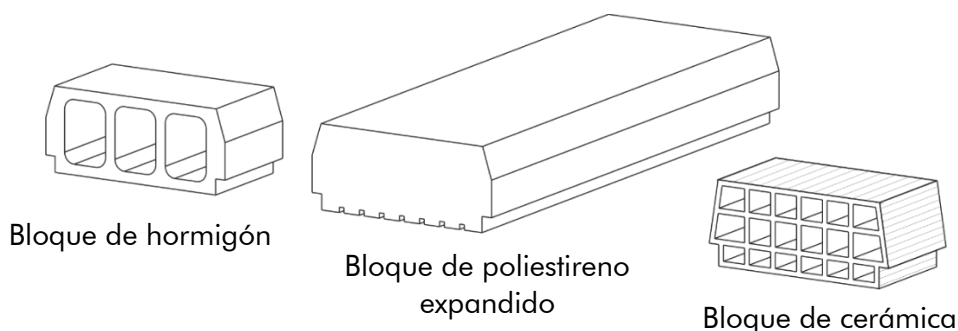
Bloques de alivianamiento para losas de viguetas
